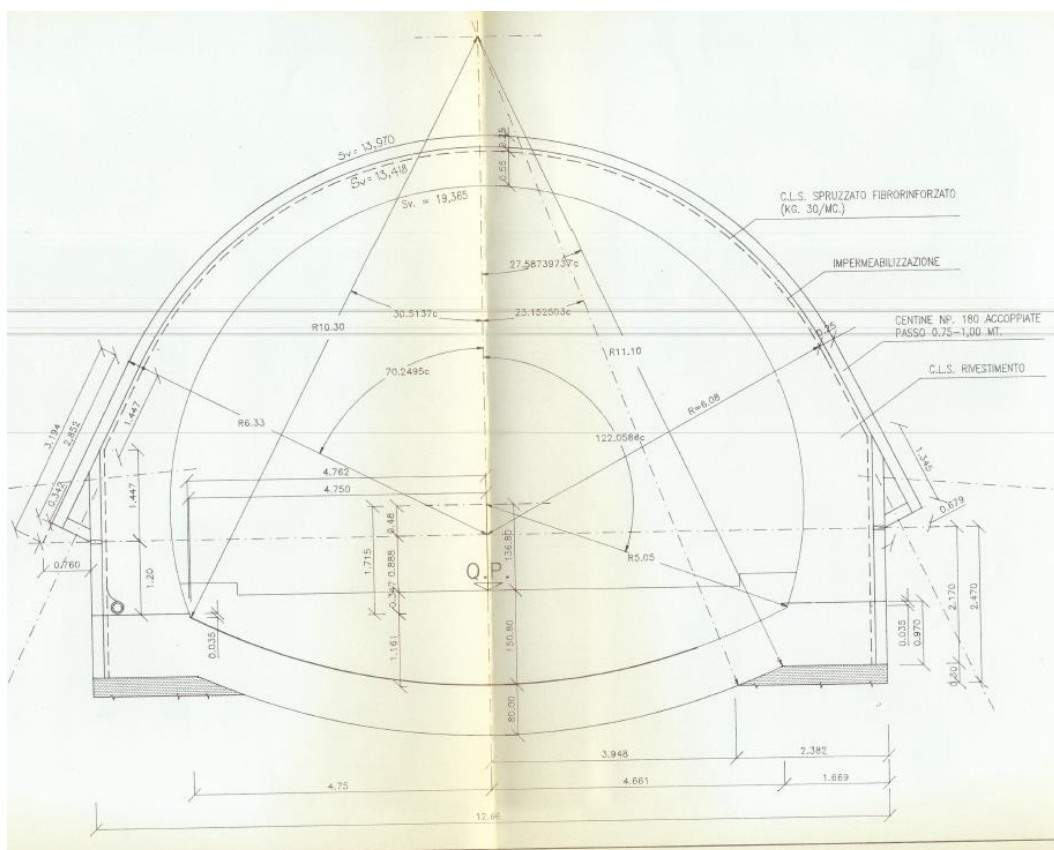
Sezione tipo Classe Vc con arco rovescio
